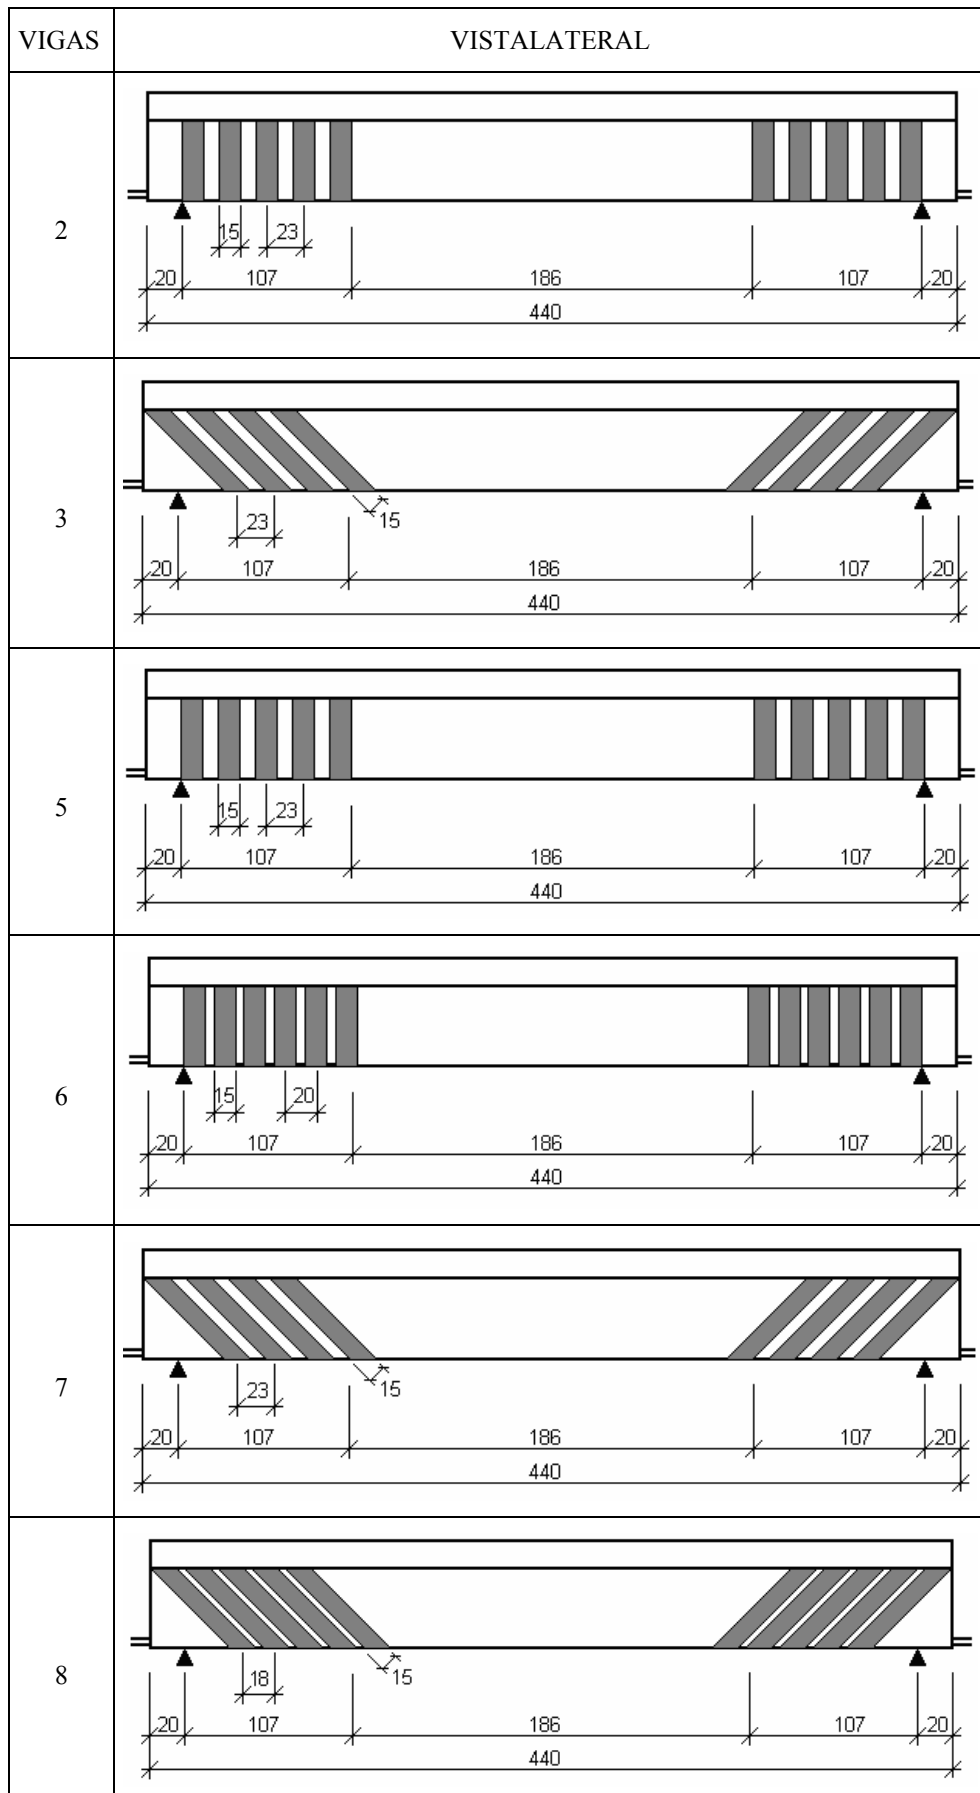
Representação do sistema das vigas reforçadas (SALLES NETO, 2000)
